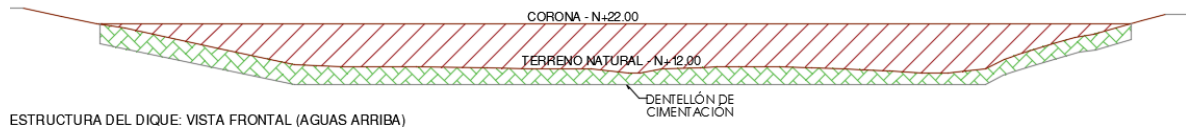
Dique vista frontal. Fuente: Fernando Mite
